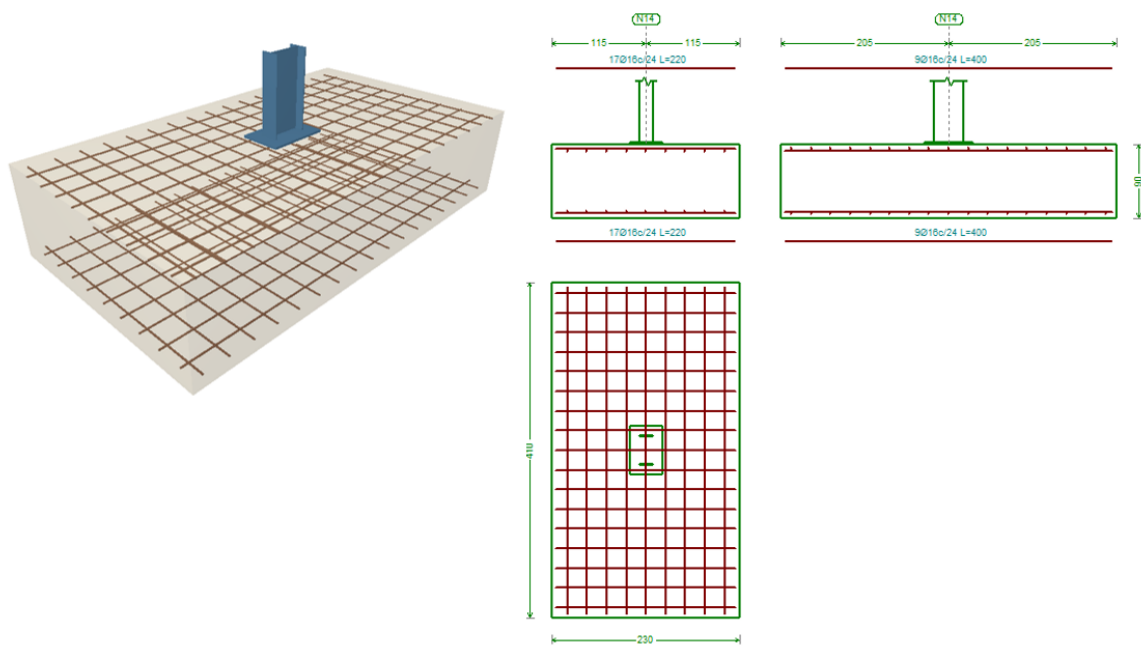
Zapata Rectangular excéntrica. Pilares exteriores de los pórticos interiores
